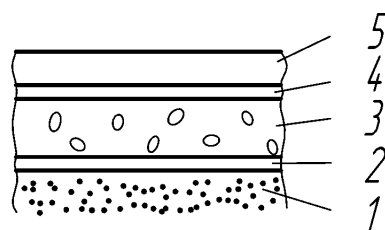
Элементы пола по грунту: 1 - основание; 2 - гидроизоляция от грунтовых вод; 3 - подстилающий слой; 4 - гидроизоляция от производственных вод; 5 - покрытие
